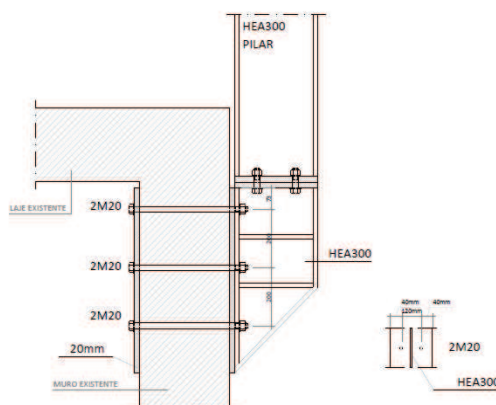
Pormenor de fixação dos pilares no edifício existente conforme projeto inicial.
